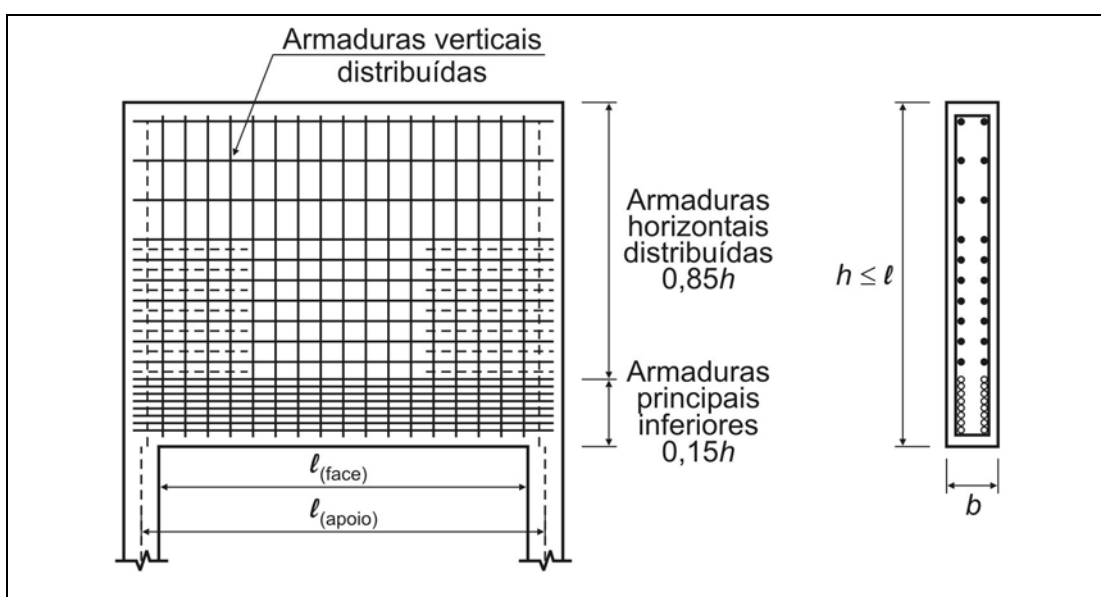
Armação típica de viga-parede com $h \leq l$
